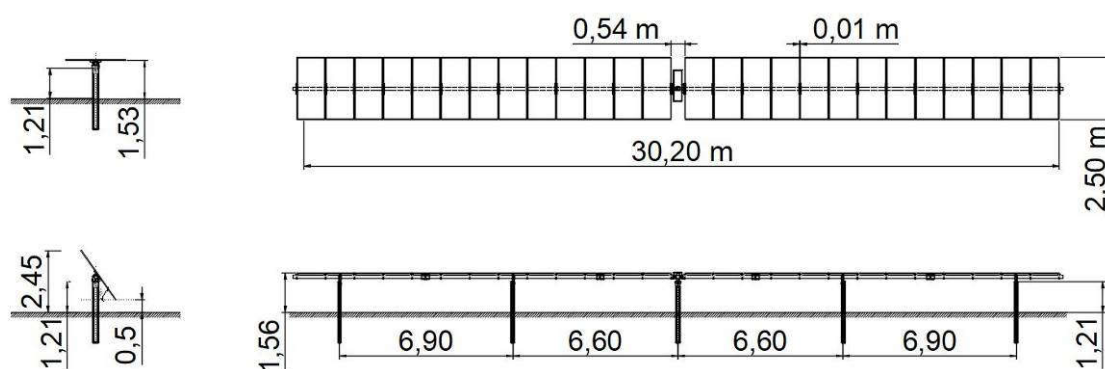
prospetto e pianta struttura di sostegno metallica dei moduli fotovoltaici
